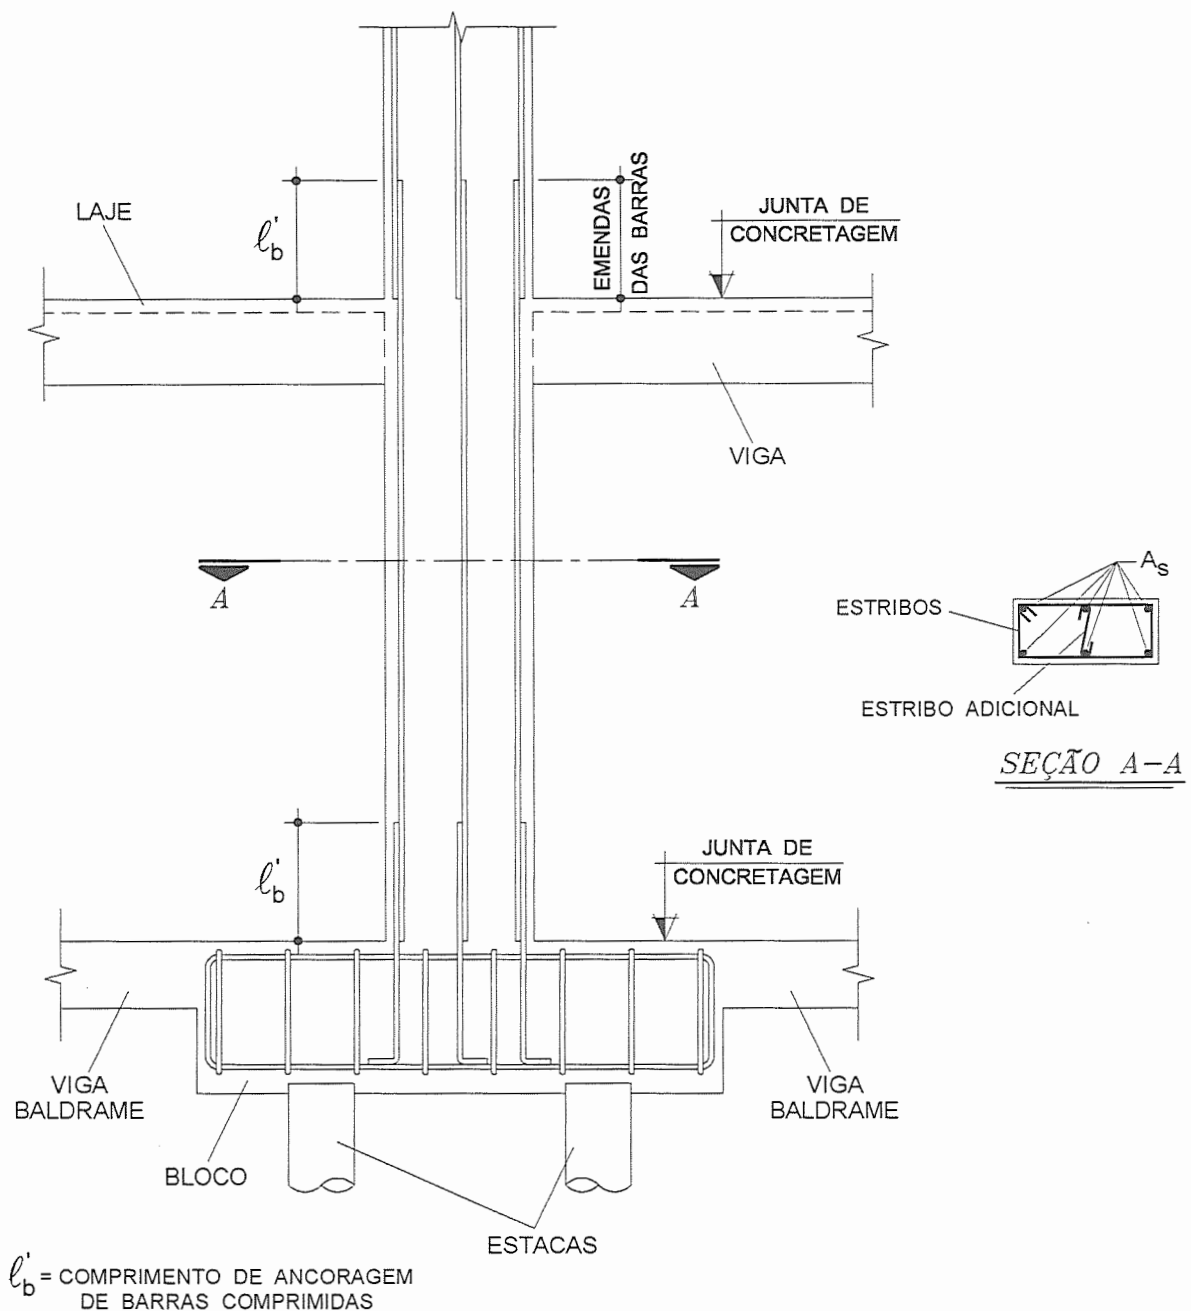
Pilares: ancoragem da armadura longitudinal.
